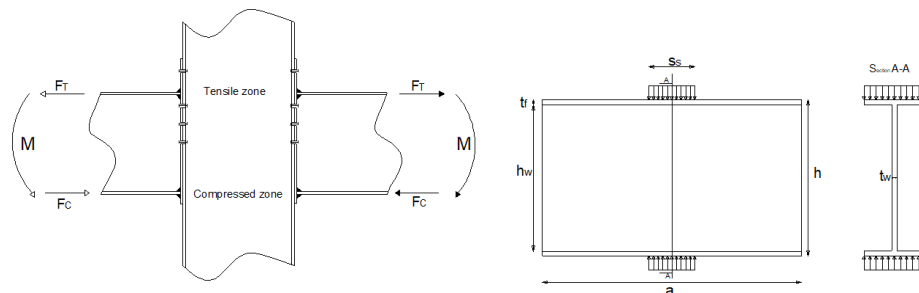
Assemblage poutre-poteau et modèle de profilé équivalent à la zone comprimée.
